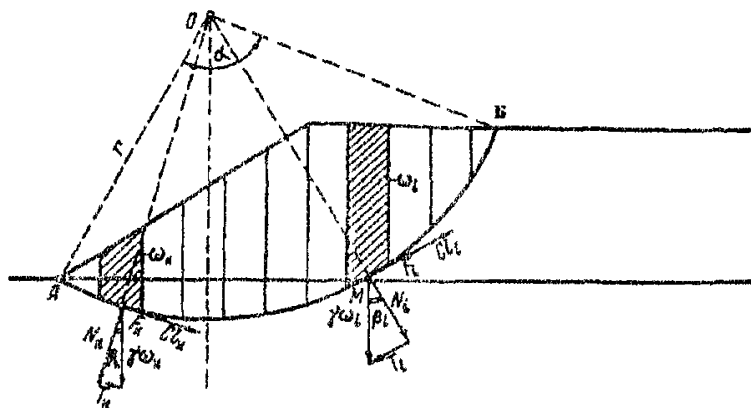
Схема разбивки на блоки поперечного сечения насыпи из однородных грунтов
